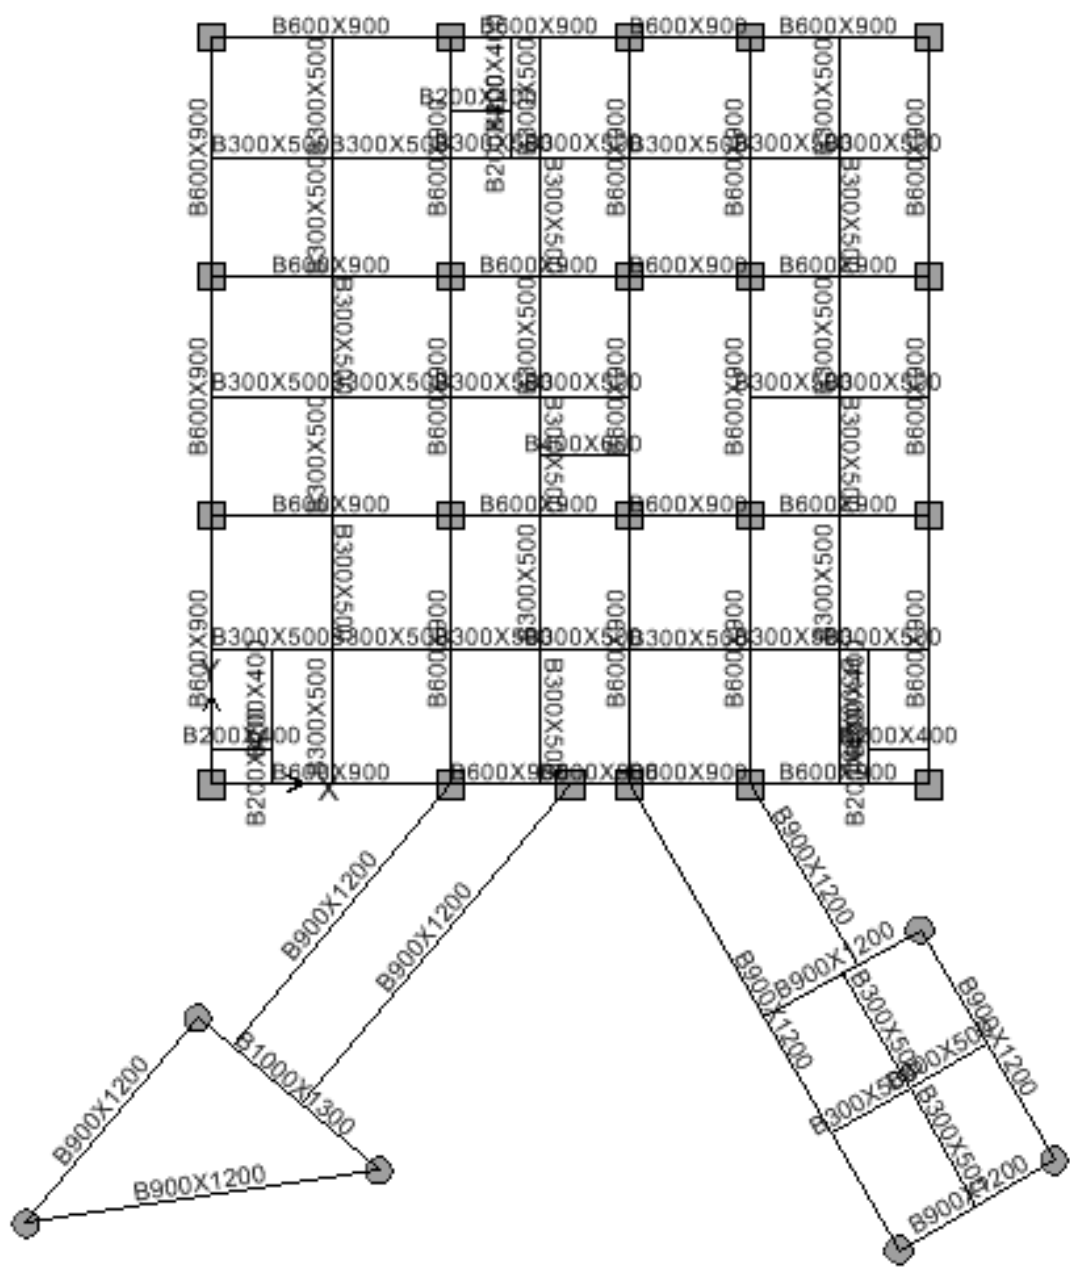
Denah Lantai 2, 4, 6, dan 8
